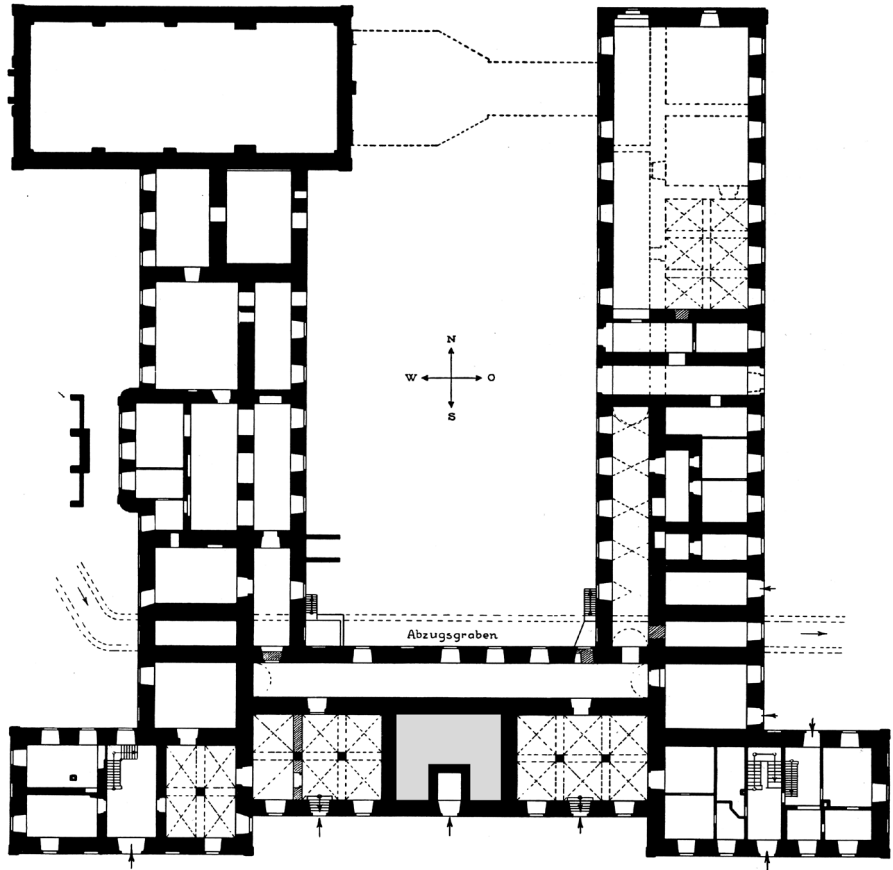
Kloster Bredelar, Grundriss des Kellergeschosses.
